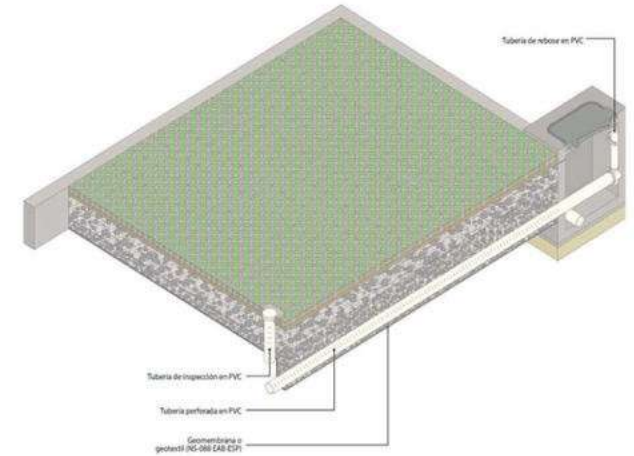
Planta: Pavimento permeable de tipo adoquines entrelazados
